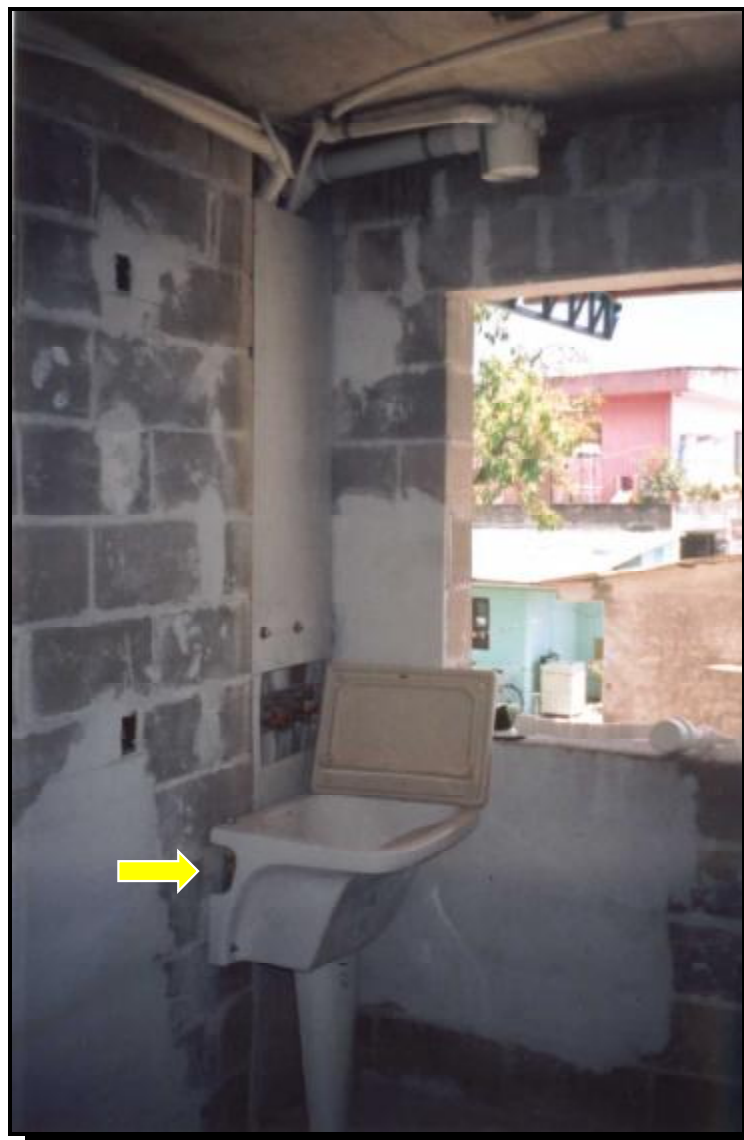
Instalações hidrossanitárias executadas com PVC e PEX externamente.
